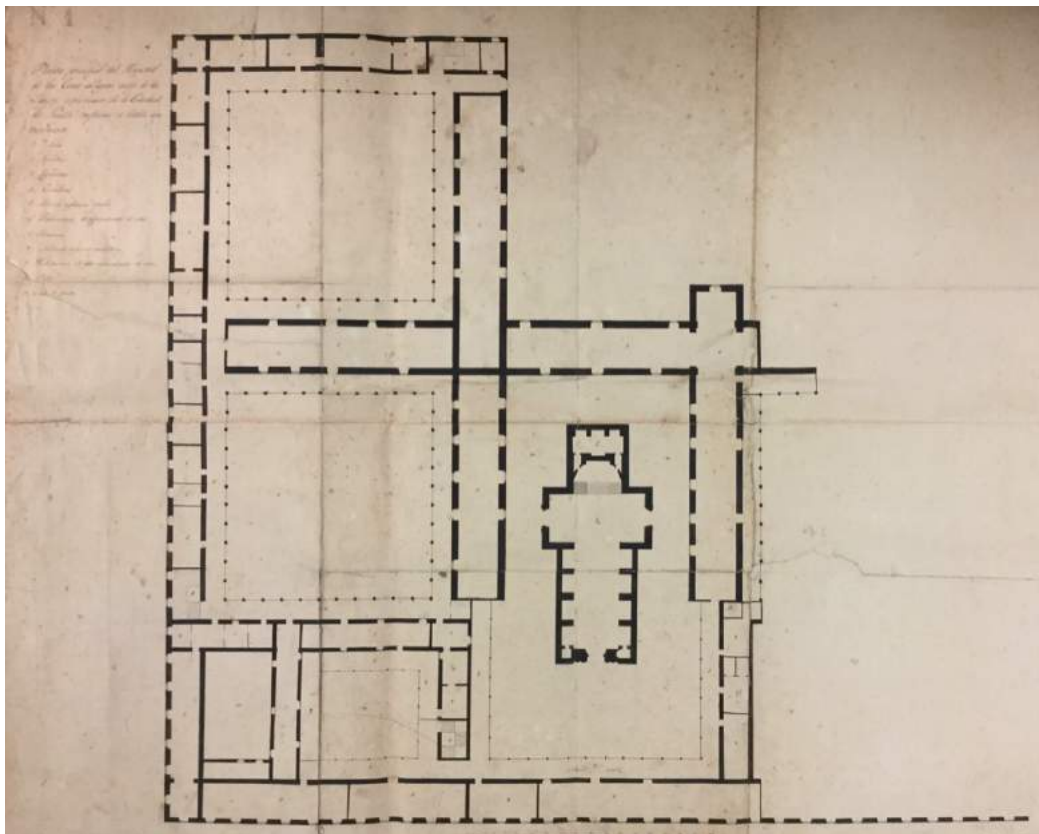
Plano de la planta alta del Hospital de las Cinco Llagas, 1852-53
